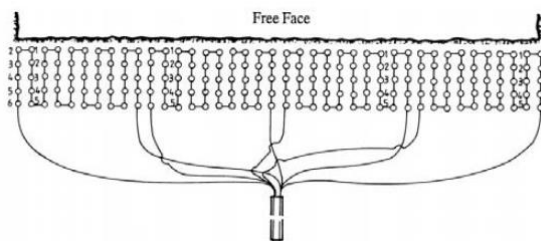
Esquema de um circuito, de detonadores eléctricos, em paralelo (Rock Excavation Handbook Tamrock, 1999)
